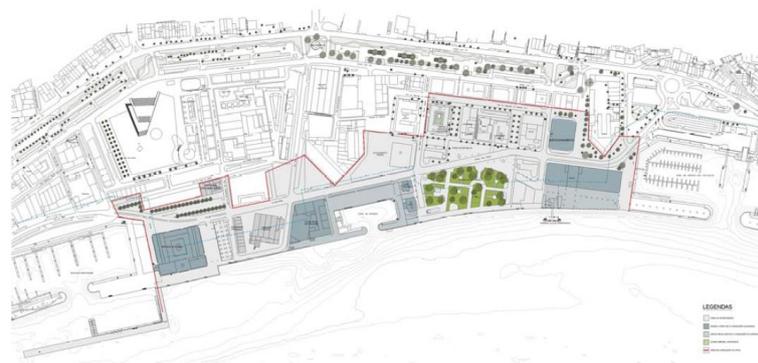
Planta da situação existente - identificação da área de intervenção (Fonte PDA)
